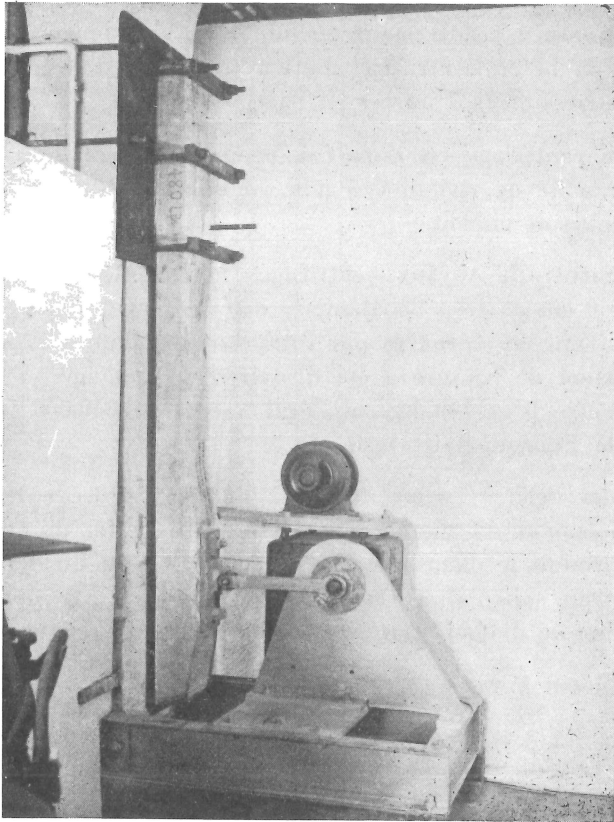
Dispositif d'essai de flexion alternative de la traverse type B.
